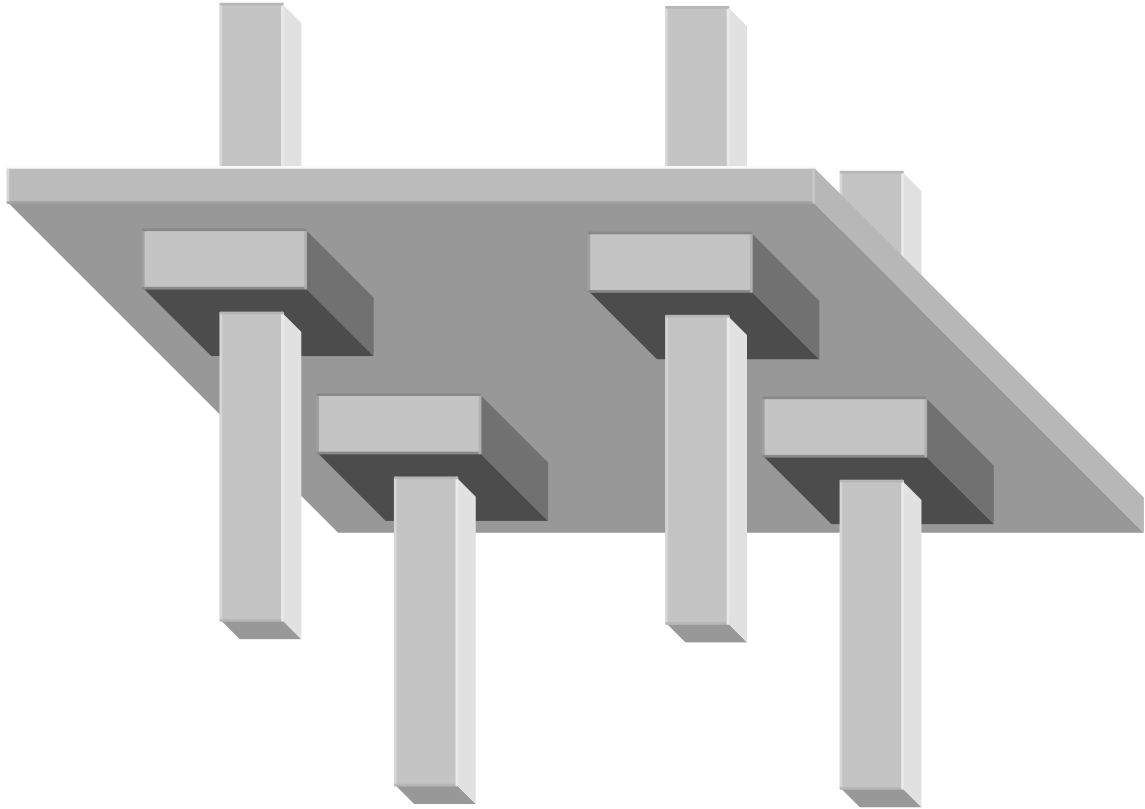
Sistema estrutural com laje plana (“flat slab”) e painel de transição (“drop-panel”).
